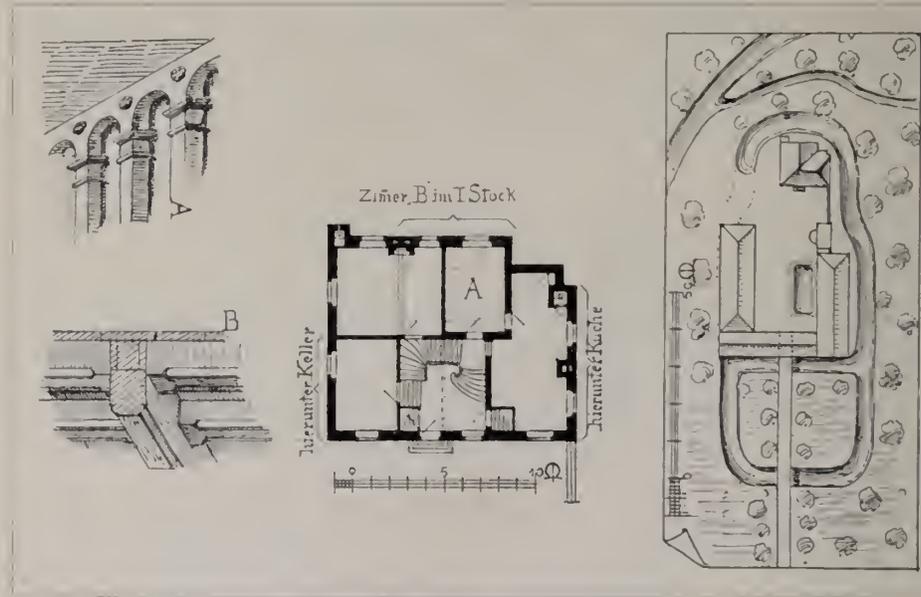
Haus Genanes. Grundriss und Details.
